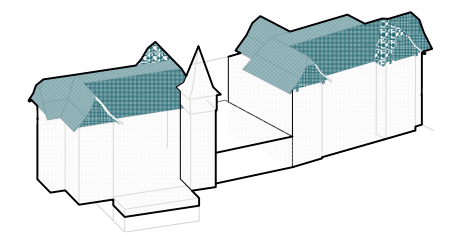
| Icon Bestandsgebäude - Dachkonstruktion (2022)
